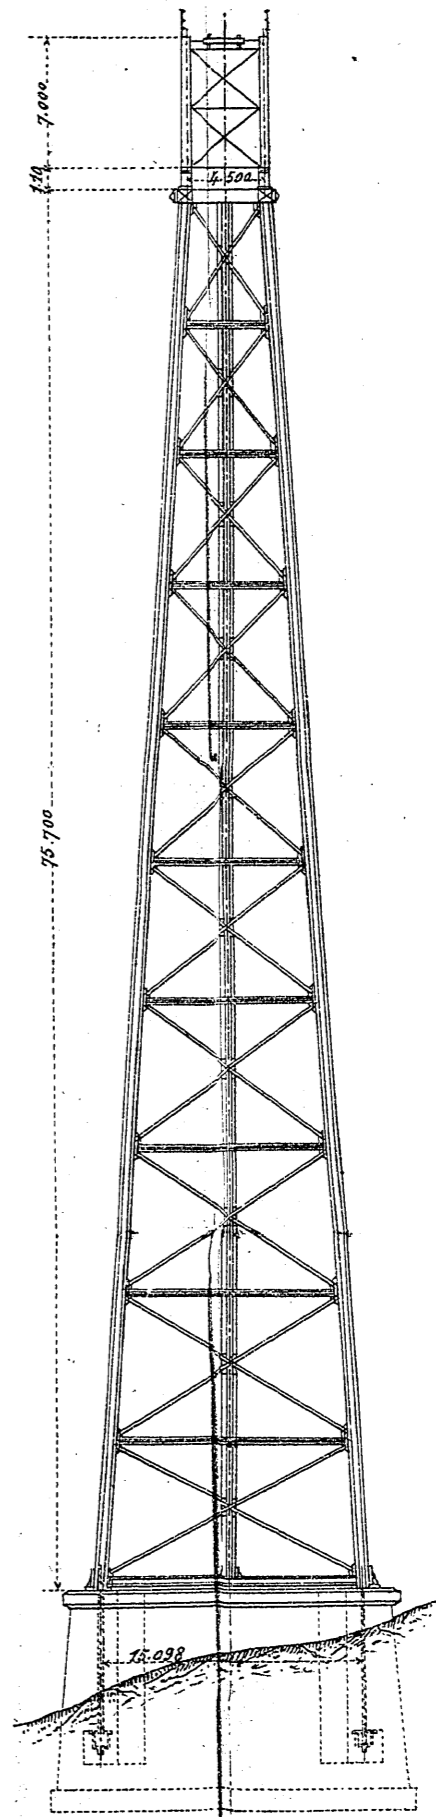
Elevacion de una pila metálica. (Escala 1/400)
